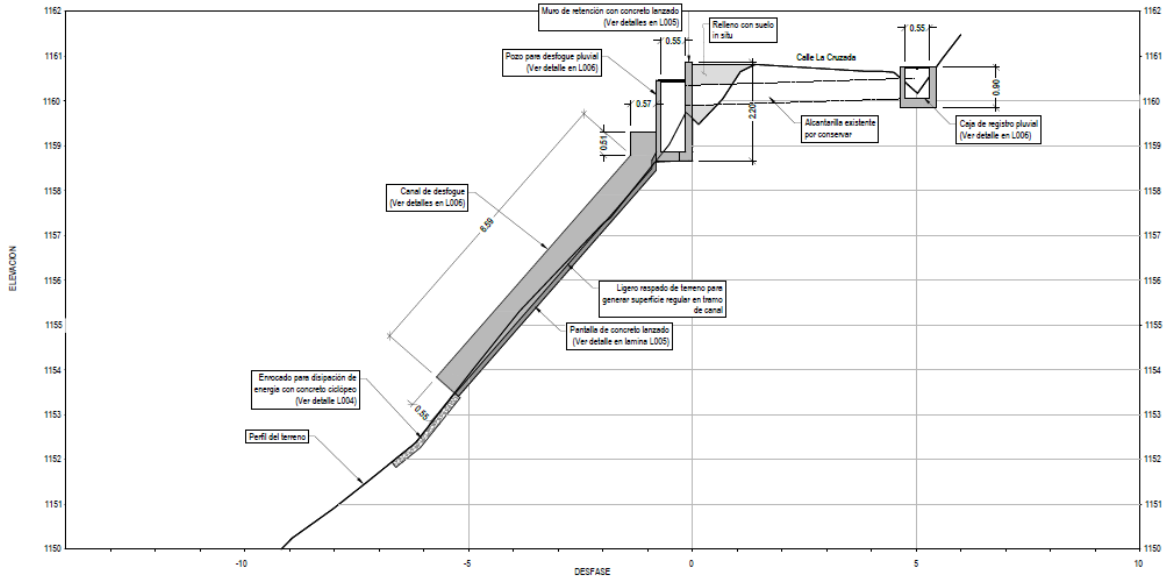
Sección D-D a lo largo del canal de drenaje de la alcantarilla pluvial.
